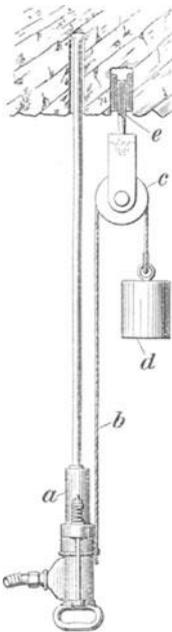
Vorschubvorrichtung für Bohrhämmer mittels aufgehängten Gegengewichtes.
